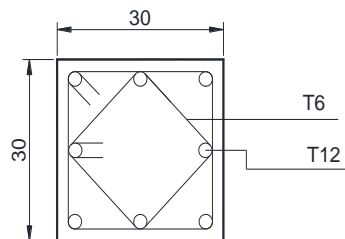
Ferrailage d'un poteau 30x30cm (poutres normales - plan fortement irrégulier)
